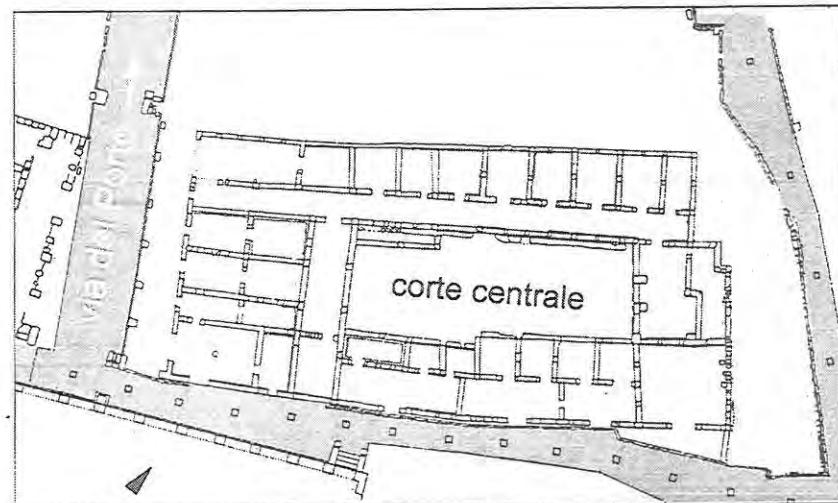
Pianta dell'insula A nella sua fase finale (rilievo di M.C. Panerai)
